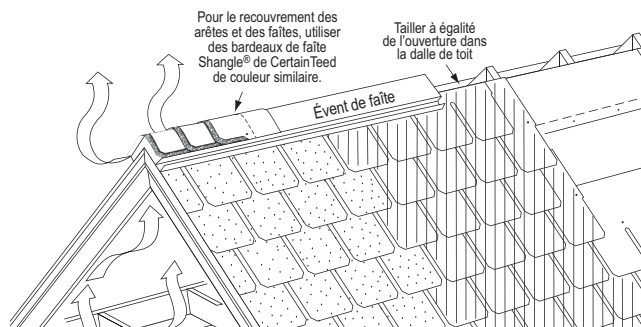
Pose de bardeaux de faîte Shangle Ridge sur un événement de faîte.
